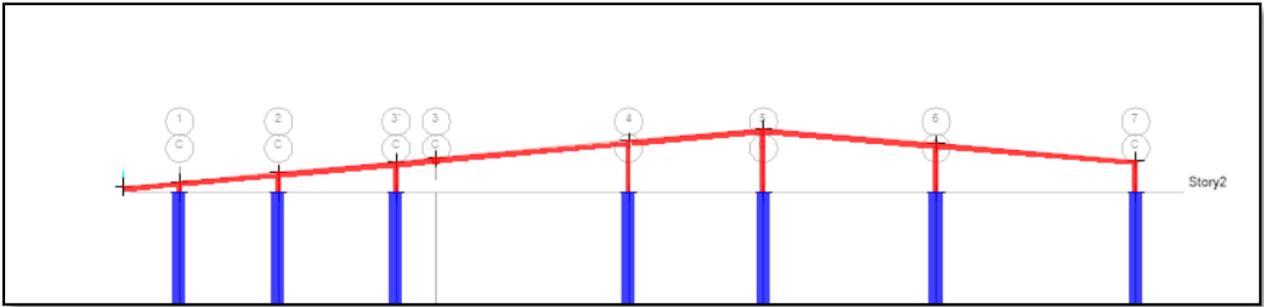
6 Corte en Elevación de Cubierta - Eje C (Rivera, J., 2024)
